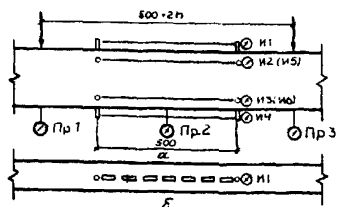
Схема расположения приборов и тензорезисторов а - вид балки сбоку; б - обжатая грань
